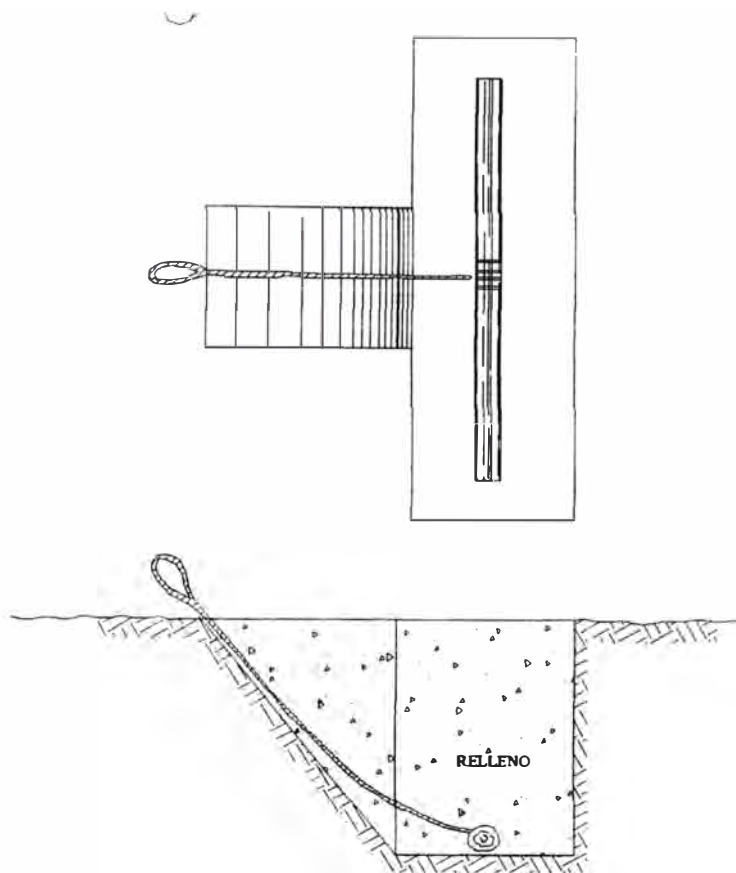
Detalle de Muertos para Anclaje de Equipos y Cables
